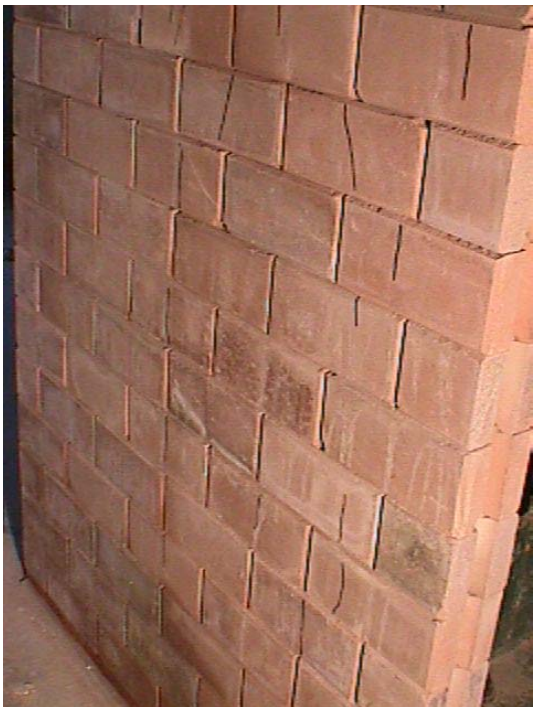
(à esquerda) – Fissuração da parede P2 com 24 fiadas, face sul inferior, durante a aplicação de carga.
